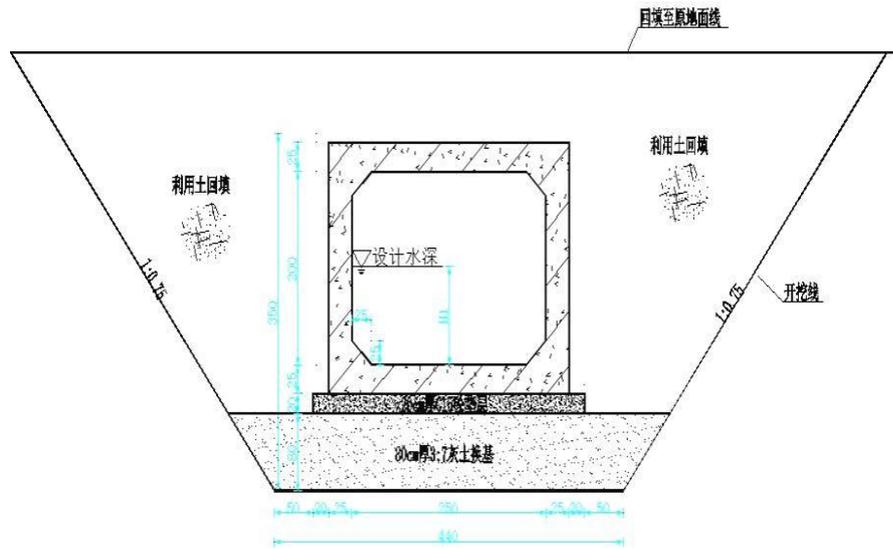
现浇钢筋混凝土矩形结构（排洪箱涵）
